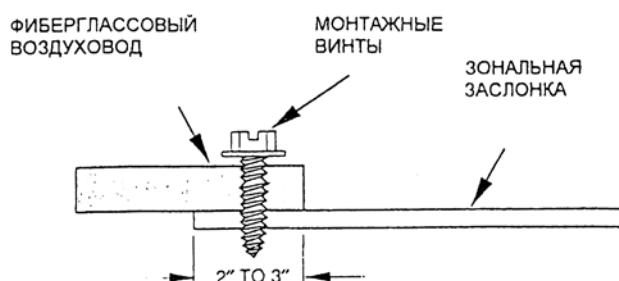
Прямоугольный фиберглассовый воздуховод
